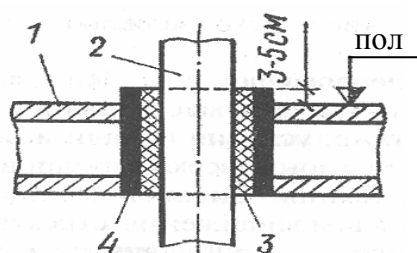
Прокладка трубопроводов через перекрытия: 1 – перекрытие; 2 – труба; 3 – асбестовая заделка; 4 – гильза
